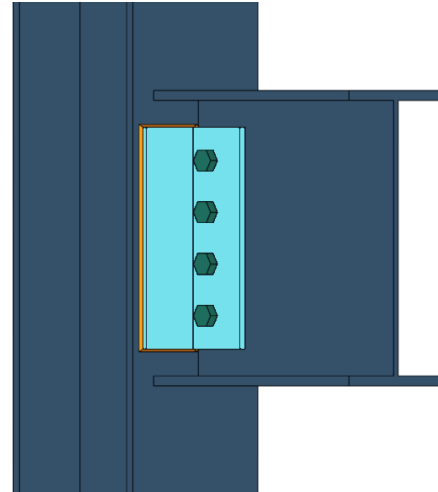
Articulation poteau-poutre par cornières soudés sur la semelle du poteau - perspective
